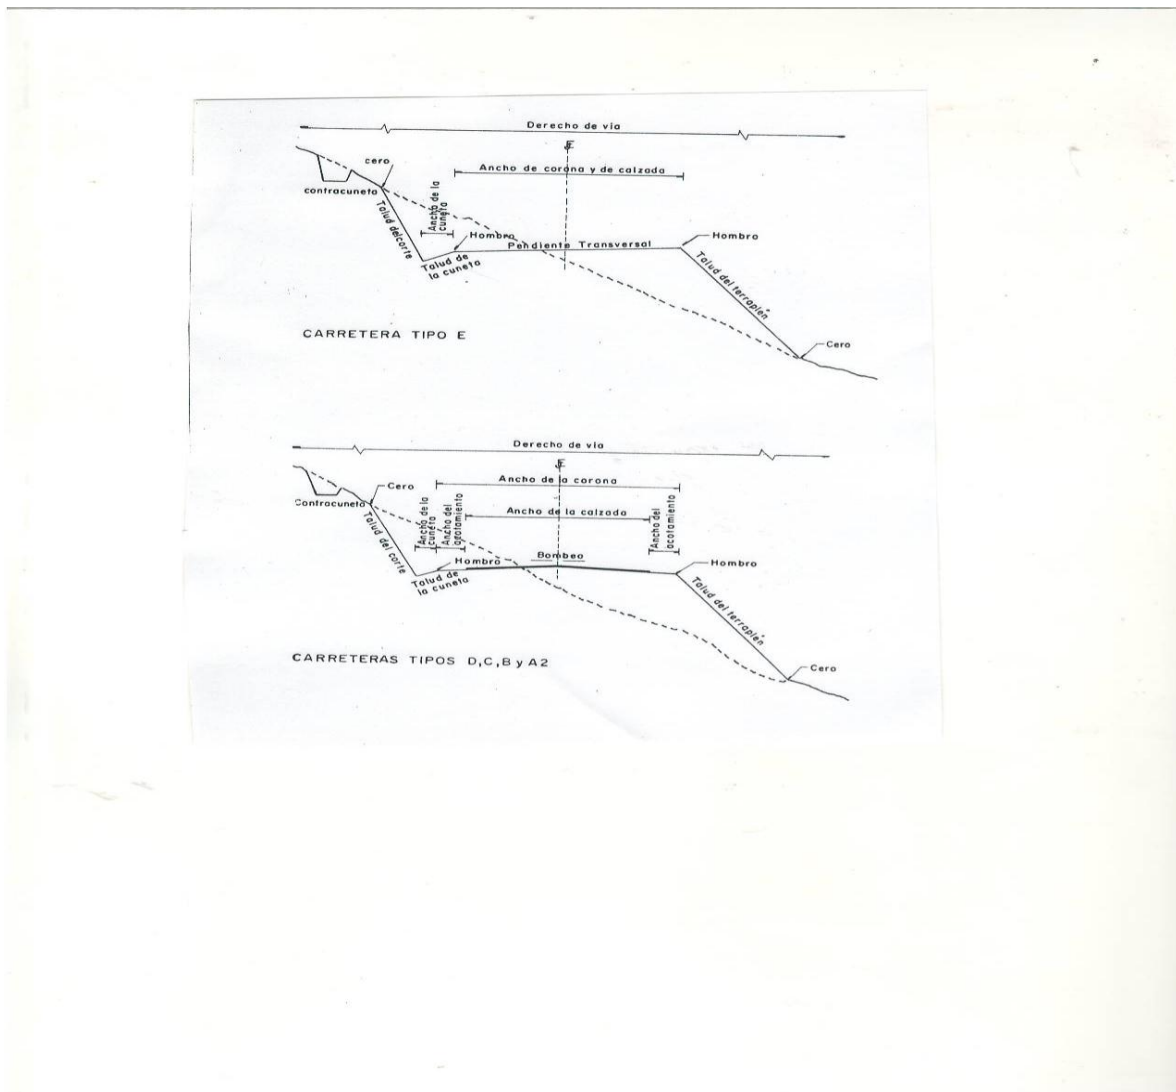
a.3 Sección transversal en tangente del alineamiento horizontal para carreteras
